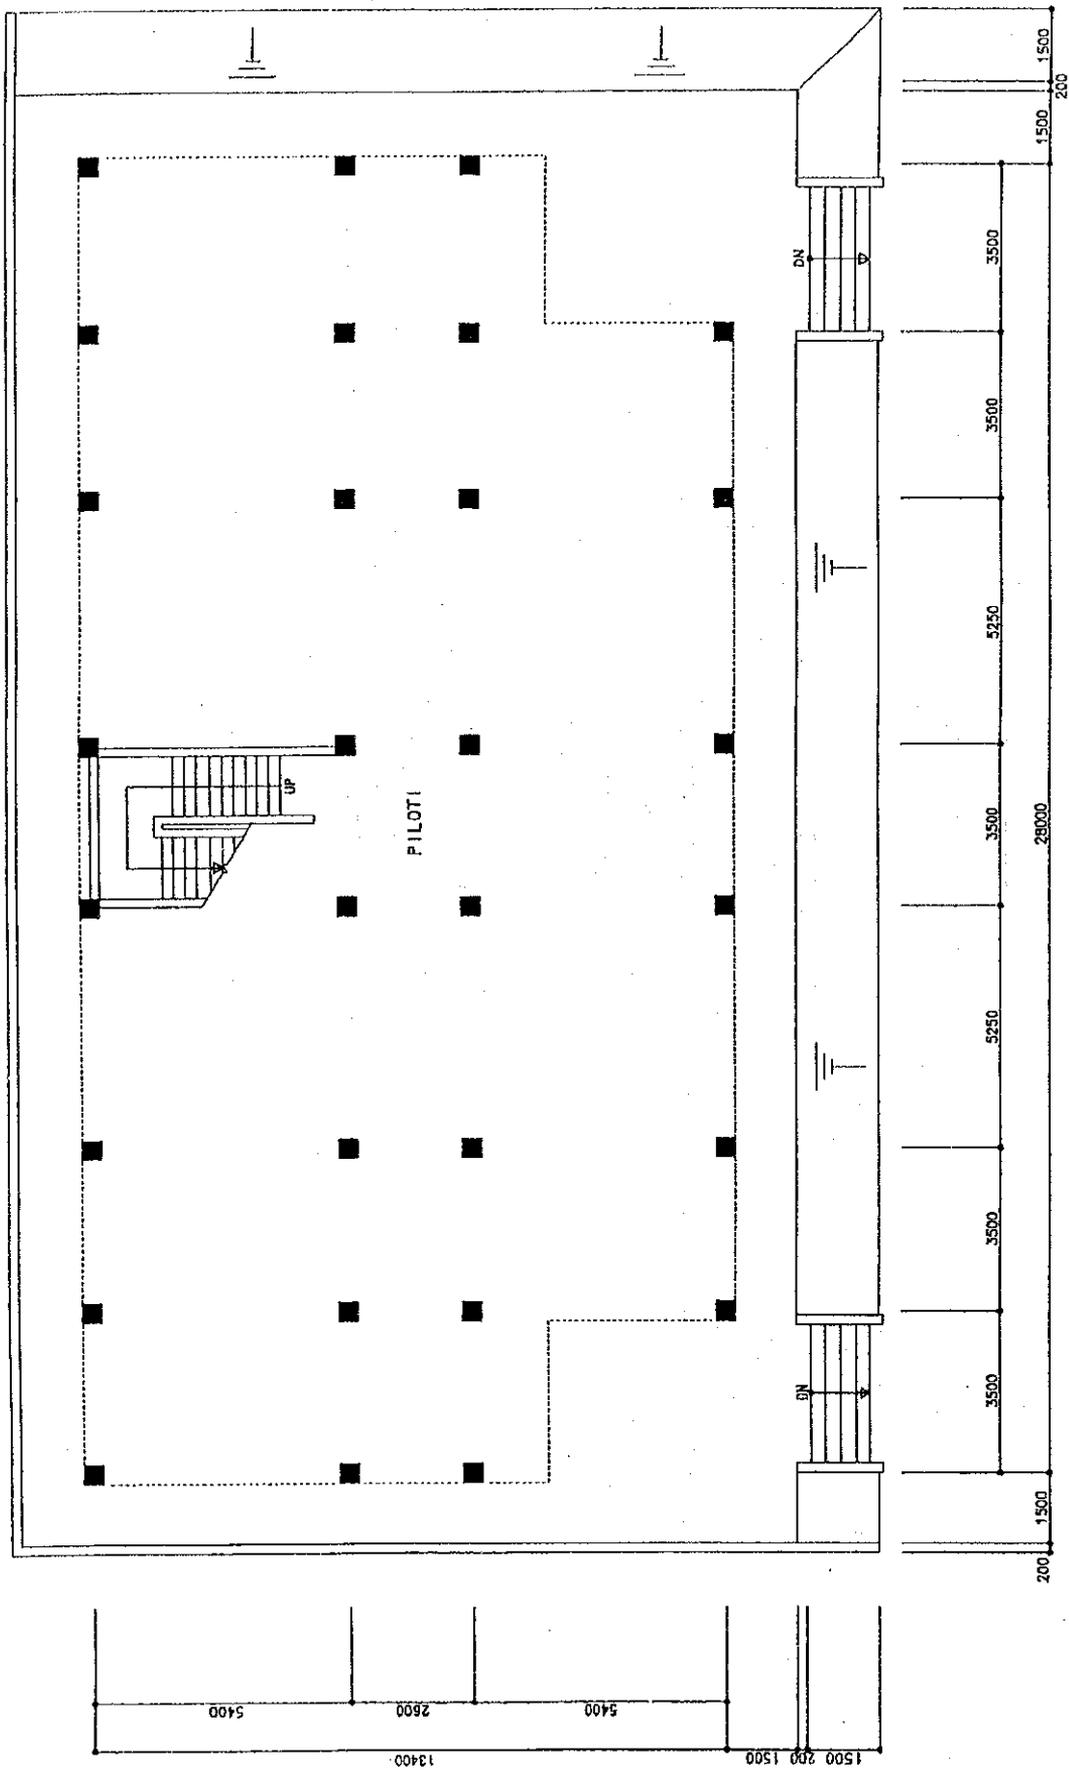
(1) 1 階平面図 (5 教室タイプ)
